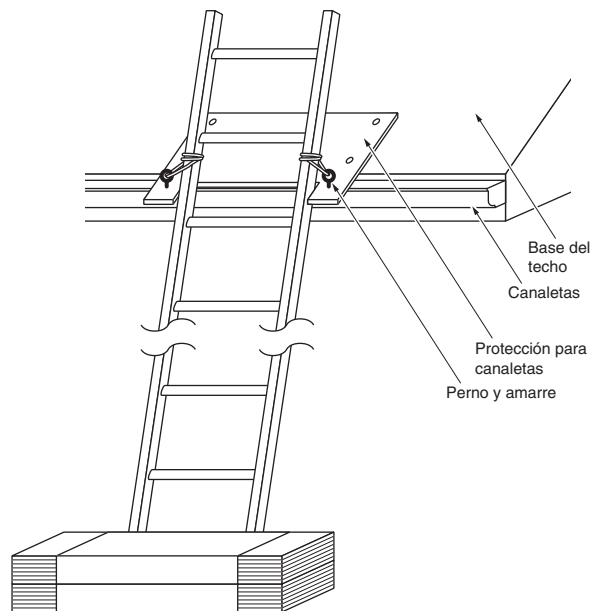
Sujete la escalera con la protección para canaletas en la parte superior y dos paquetes de tejas en la parte inferior.
